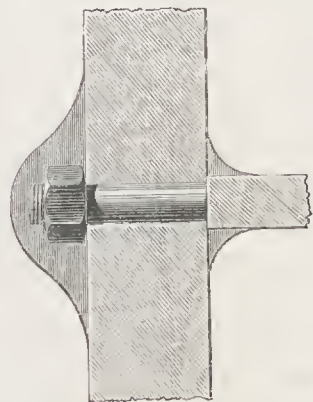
Soldadura de la barra vertical y del conductor
